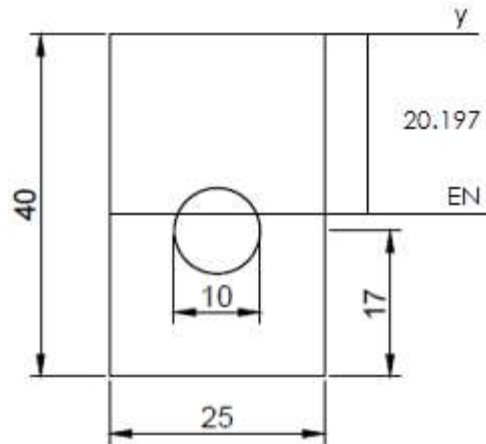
Sección de la viga de concreto con refuerzo de bambú y ubicación de eje neutro
